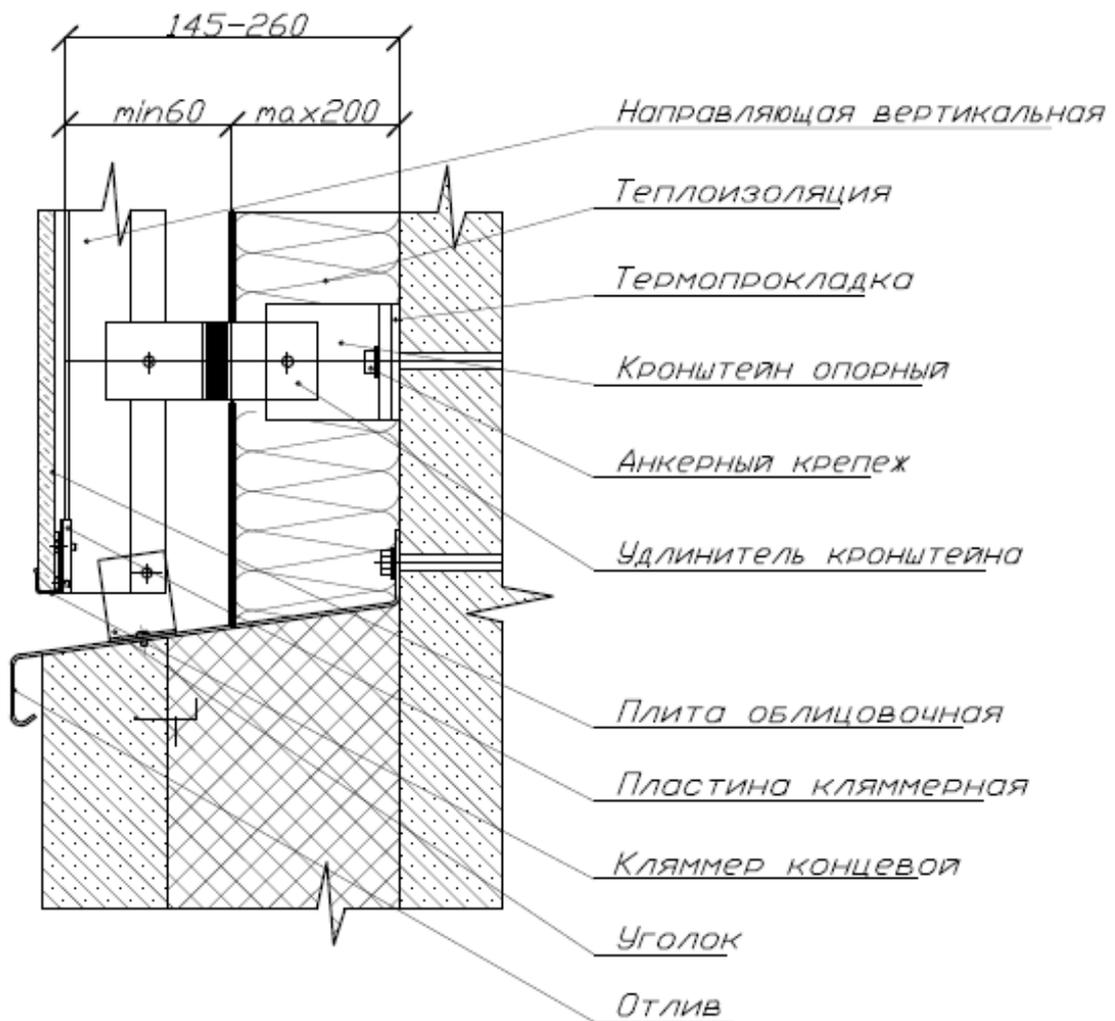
Узел 3. Устройство крепления вентилируемого фасада к наружной стене
